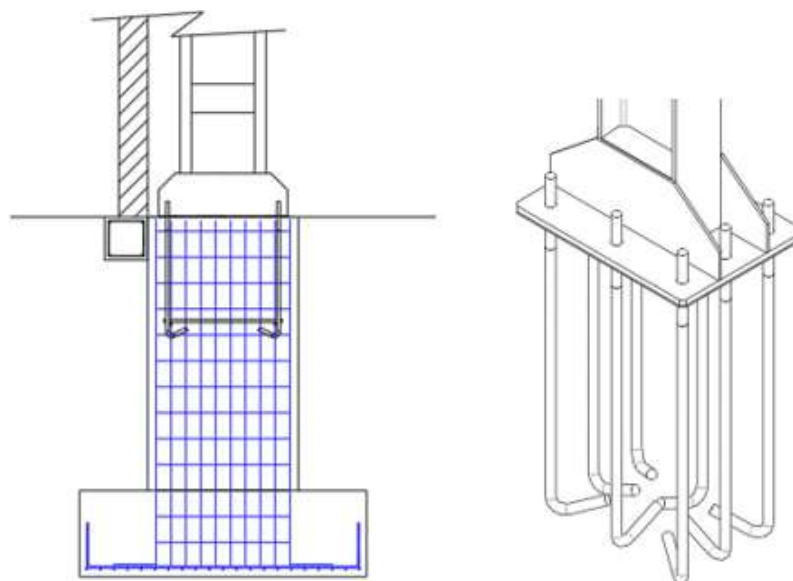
DETALLE DE ANCLAJES DE COLUMNAS.
